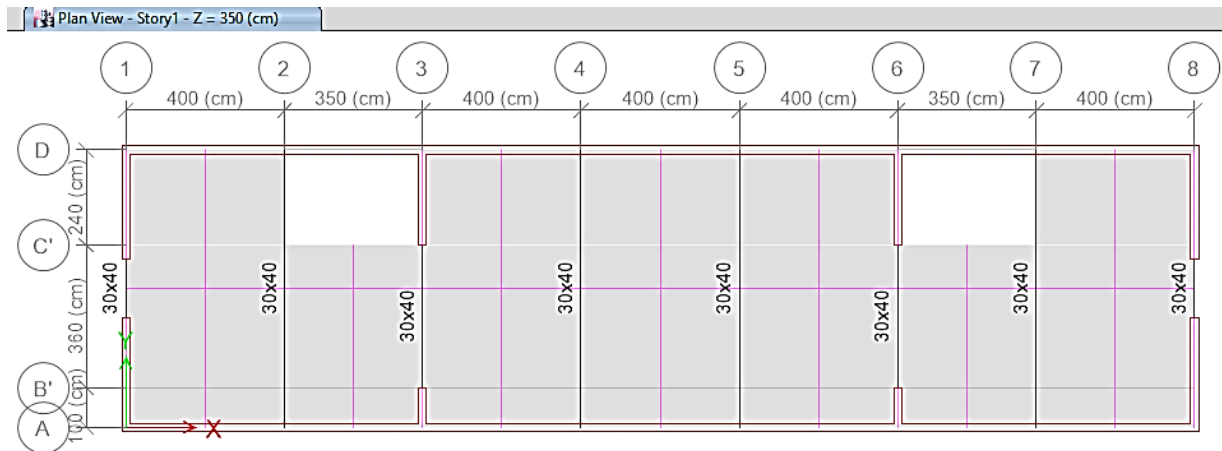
Vista en Planta del Nivel 1 del Edificio
